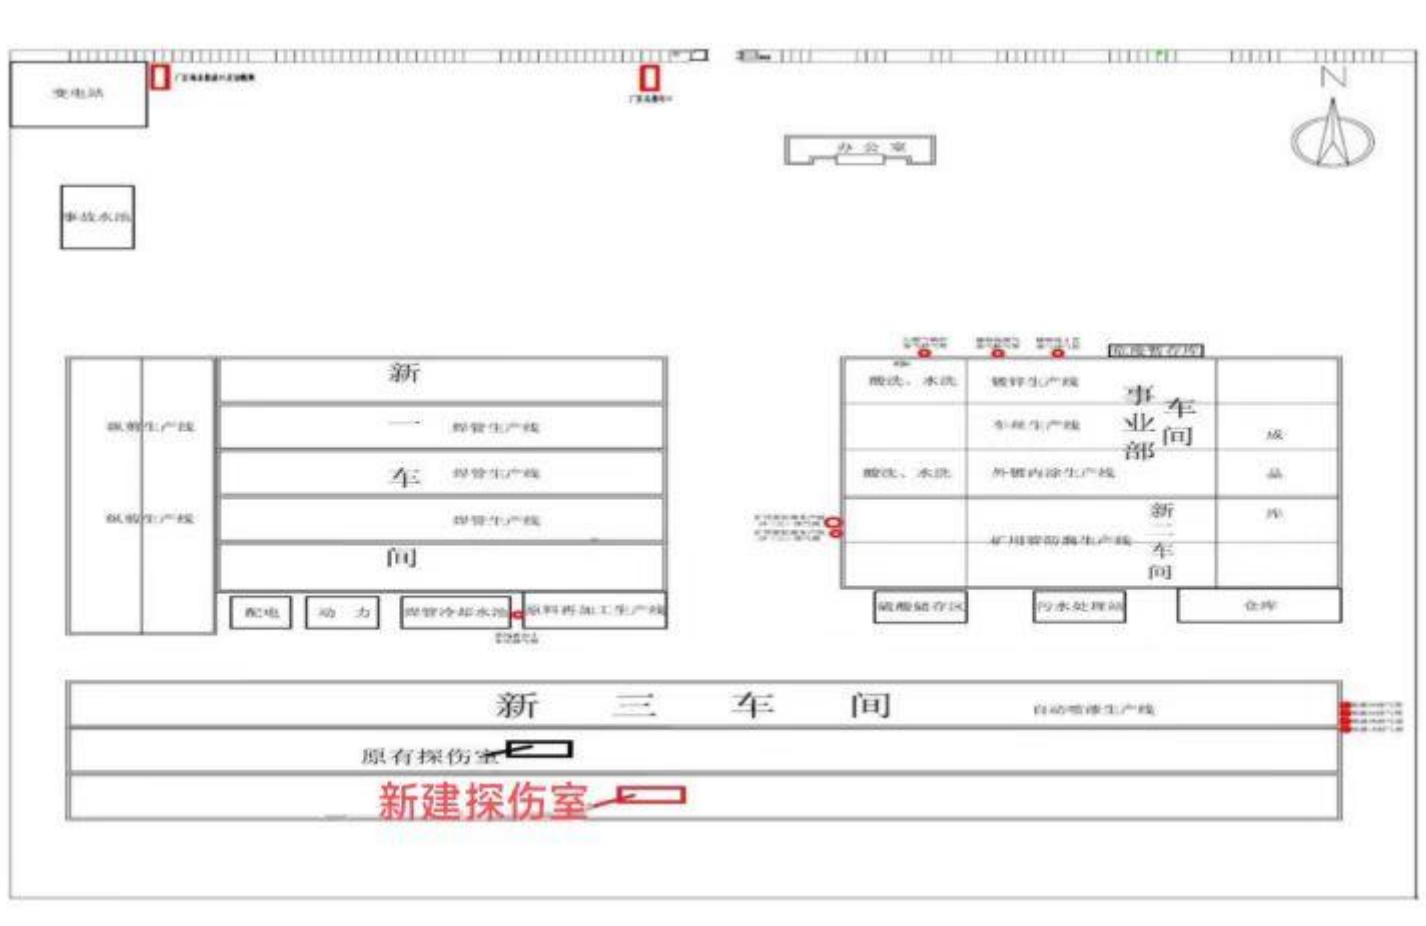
潍坊亿斯特管业科技有限公司总平面布置示意图
